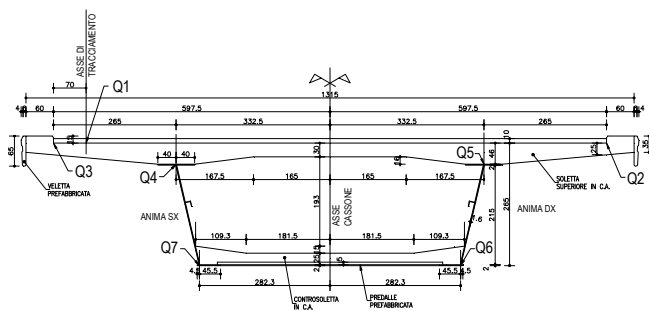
Sezione trasversale impalcato in mezzeria – Progetto Esecutivo
